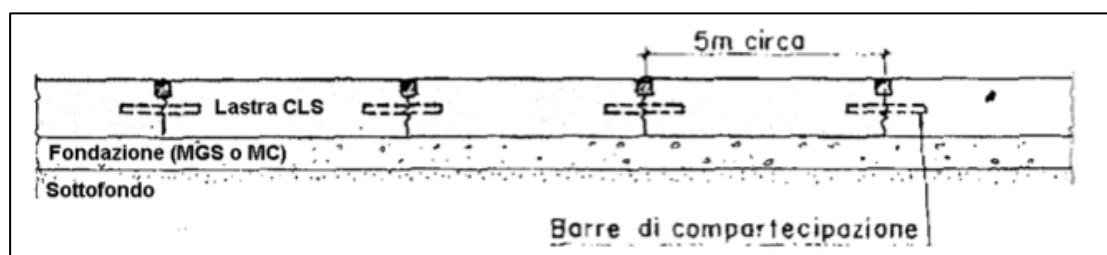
Pavimentazioni rigide con lastre non armate
